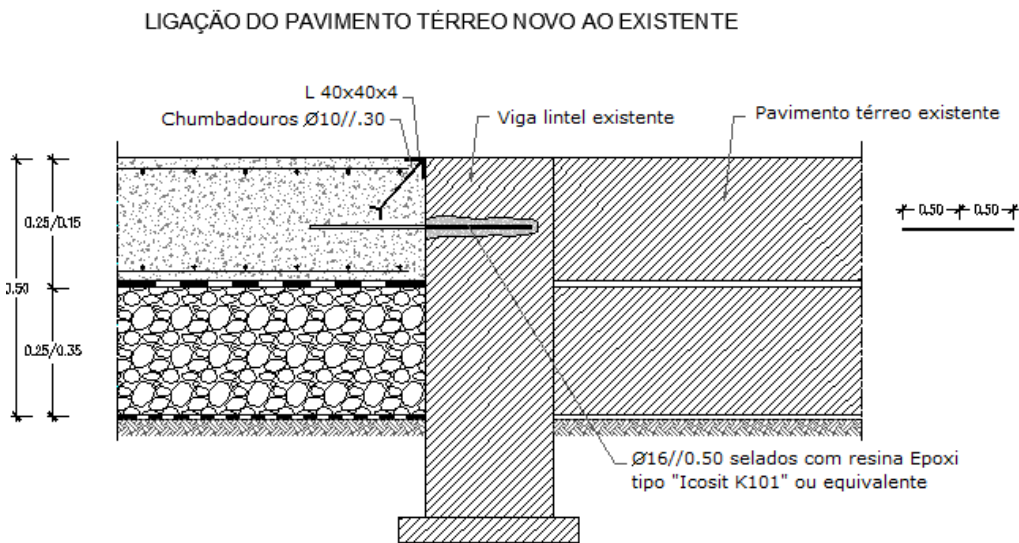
Corte tipo: Ligação do pavimento térreo novo ao existente.
